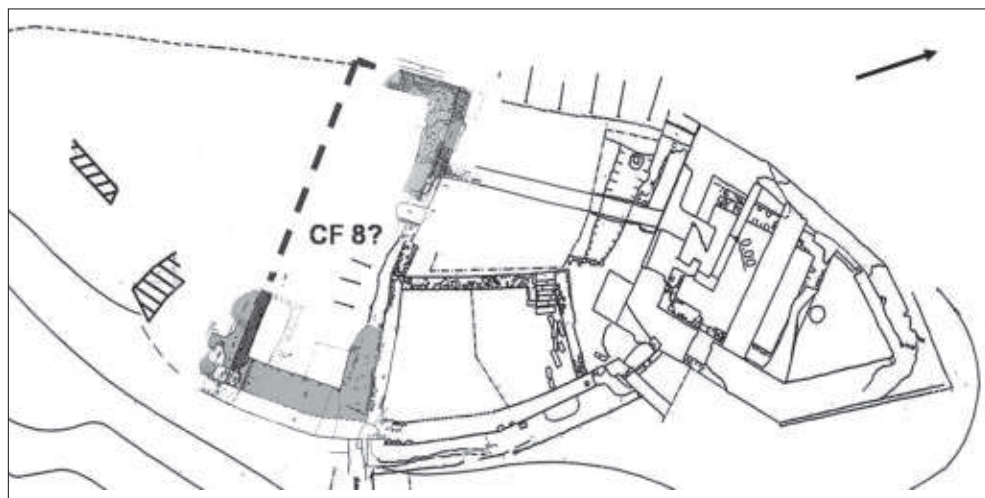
Planimetria con indicata la possibile ubicazione del CF 8.
